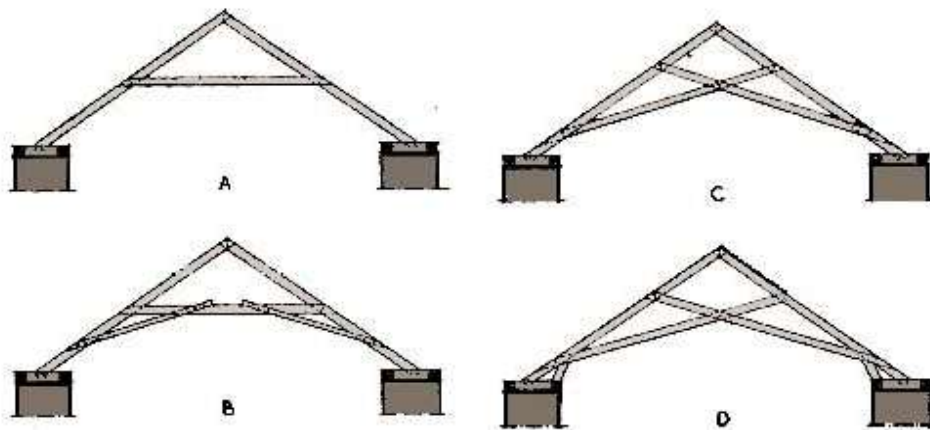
Madeiramento tipo “caibro armado”, Ouro Preto.
